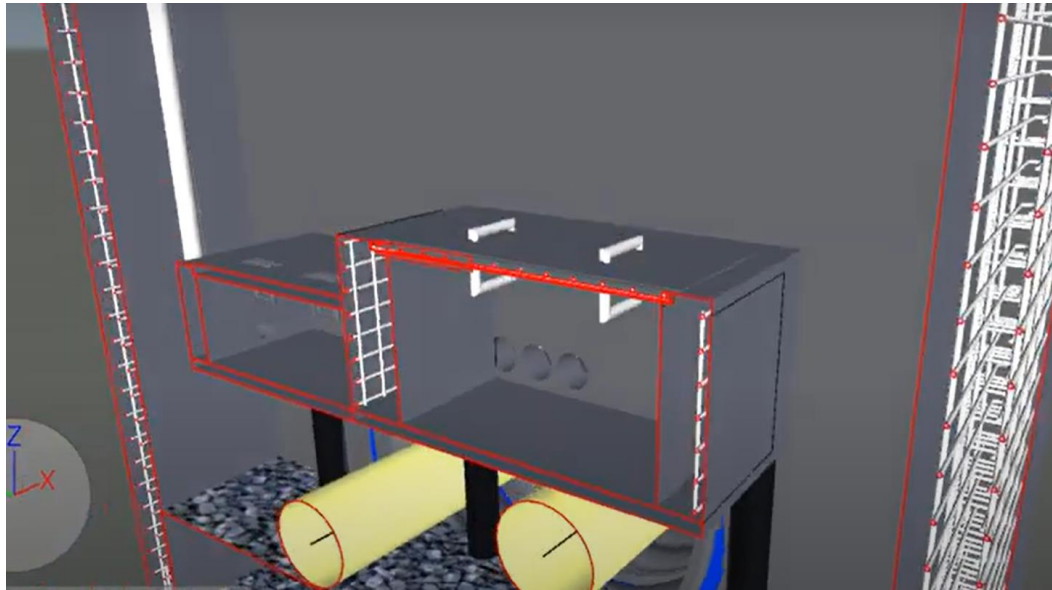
Modelo BIM caja TL cruce vía panamericana, disposición de cajas para servicio secos
